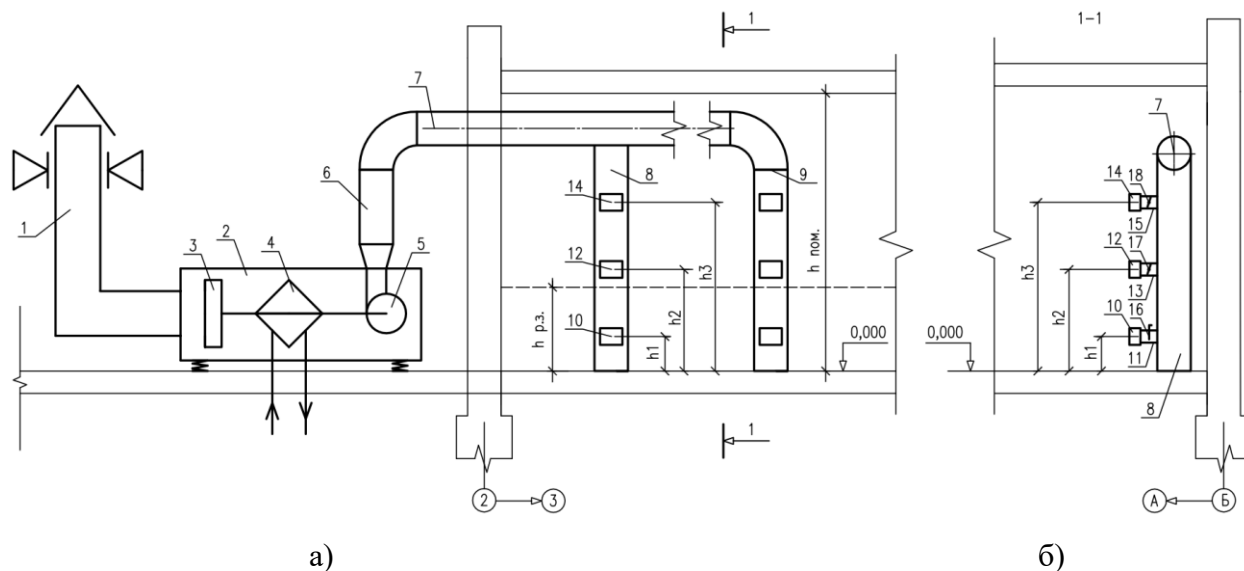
Принципиальная схема приточной системы вентиляции совмещенной с воздушным отоплением
